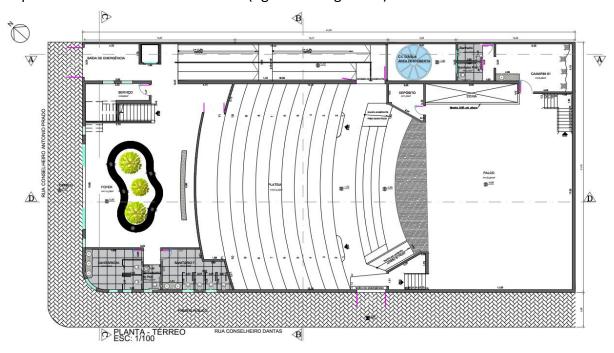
Planta de reforma do térreo. (Fonte: produção do autor)
